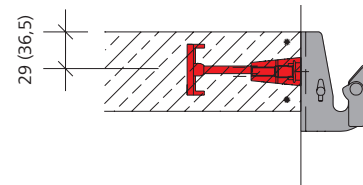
Point d'ancrage sur rive de dalle en débord (étayée)
